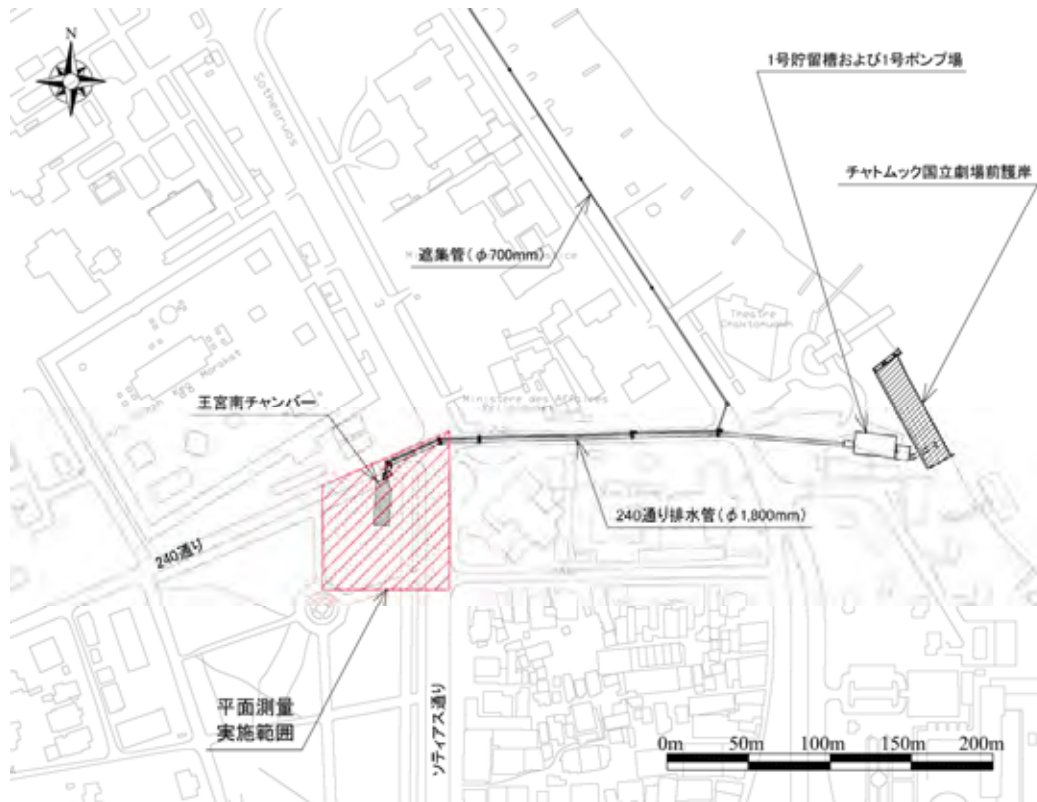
王宮南側チャンバー周辺の平面測量実施位置図
